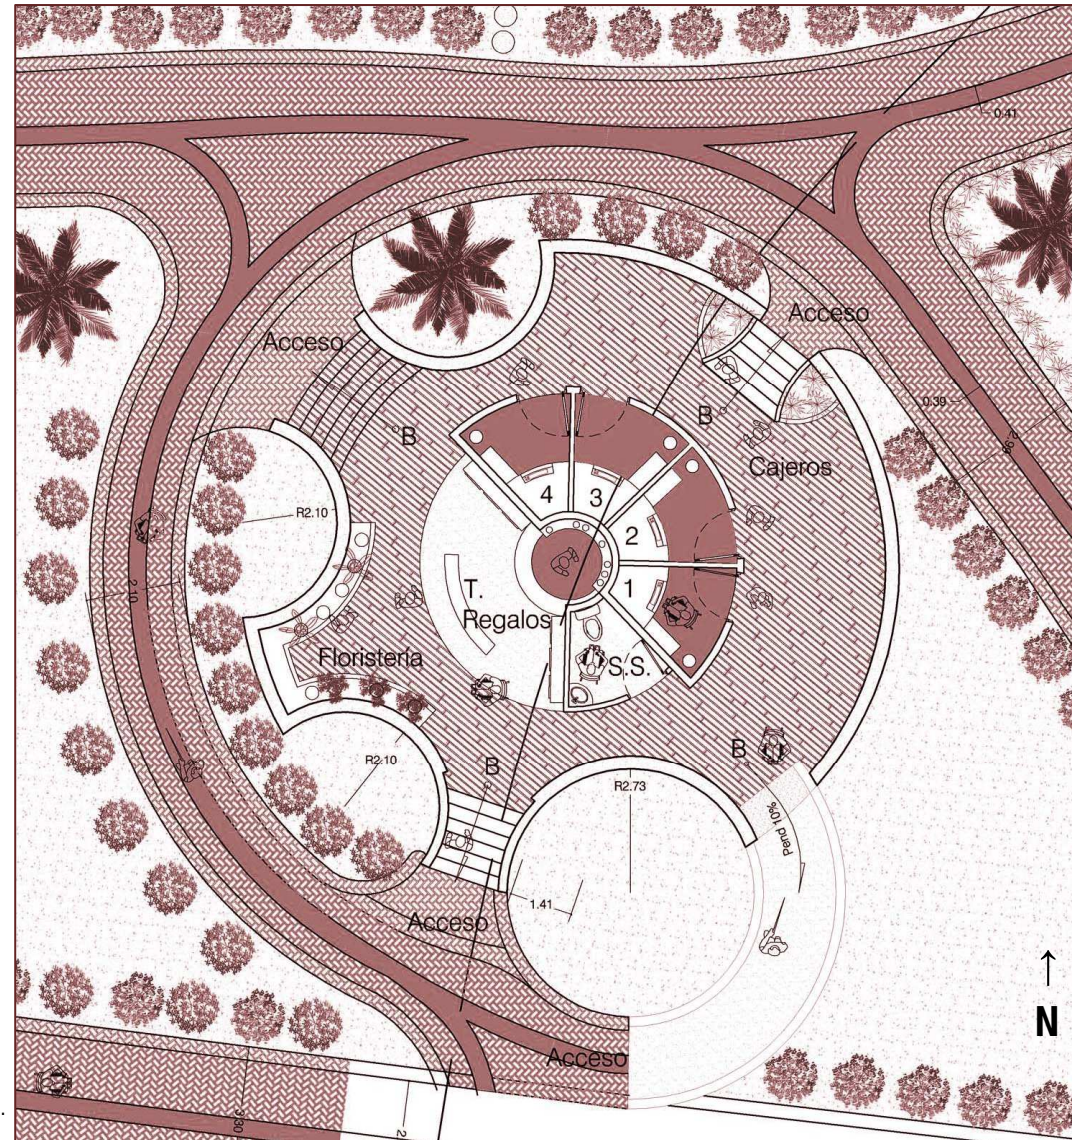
Módulo 3.Elevación.Cajeros automáticos-Floristería-Tienda de regalos.
